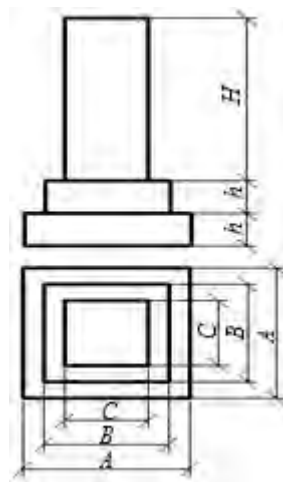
Расчетная схема фундамента, бетонируемого методом термоса
